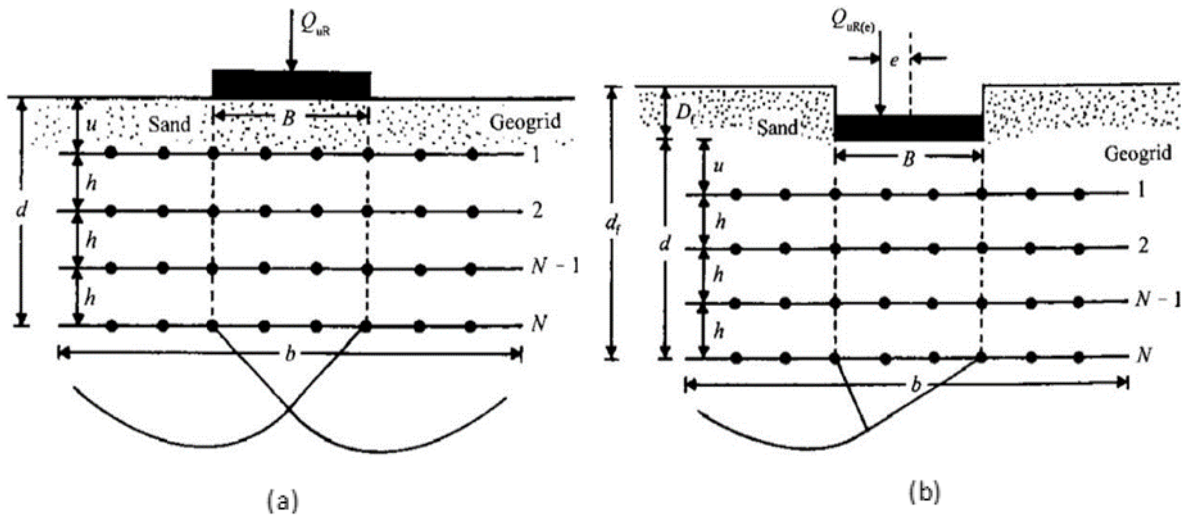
Mode de rupture d'une semelle filante située sur un sol renforcé
